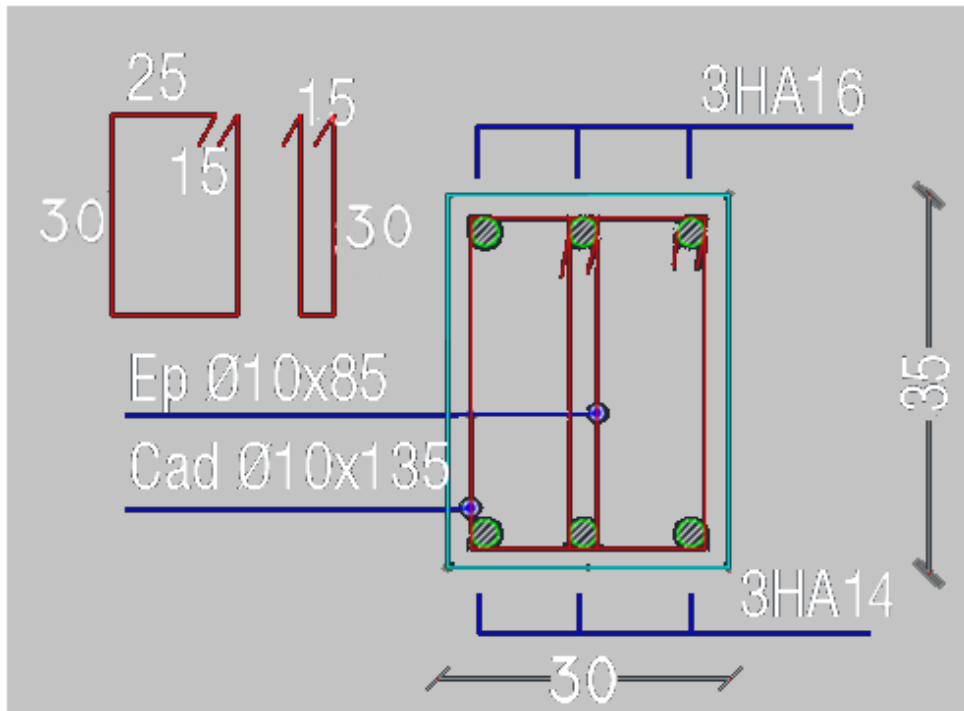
Ferrailage des poutres secondaires en travée de niveaux 8<sup>ème</sup> à 15<sup>ème</sup> étage.
